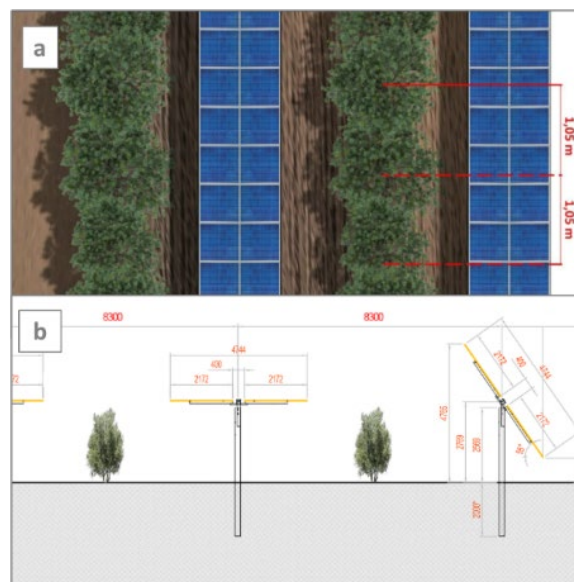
Vista Planimetrica dell'impianto Olivicolo (a) e sezione (b)
